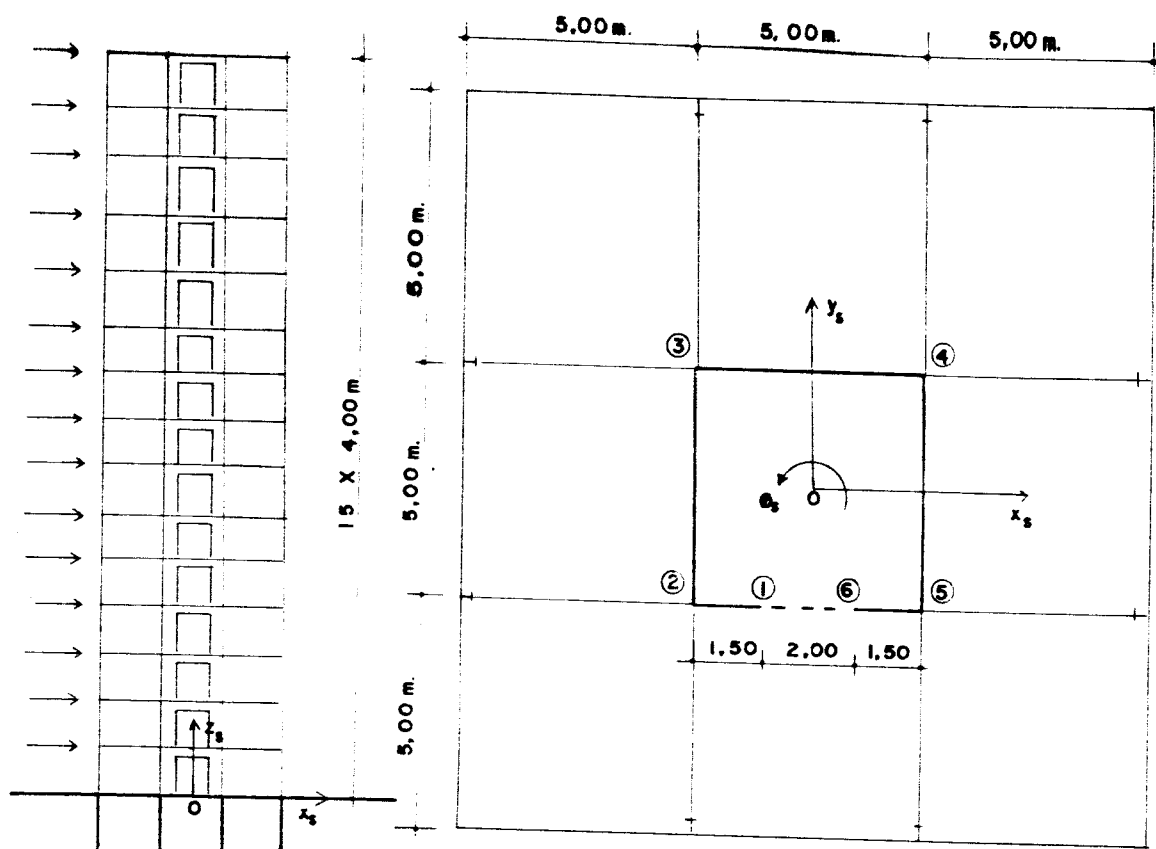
EDIFÍCIO CONSTITUÍDO DE NÚCLEO DE CONCRETO ARMADO E PILARES PERIFÉRICOS DE AÇO
